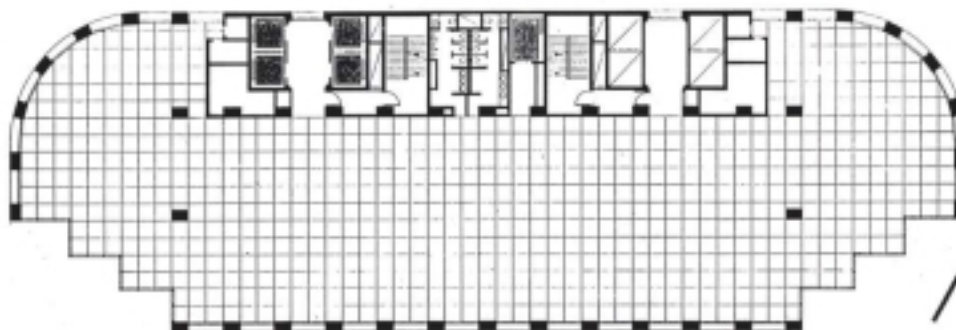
Planta pavimento tipo 2º ao 5º e 7º ao 10º
